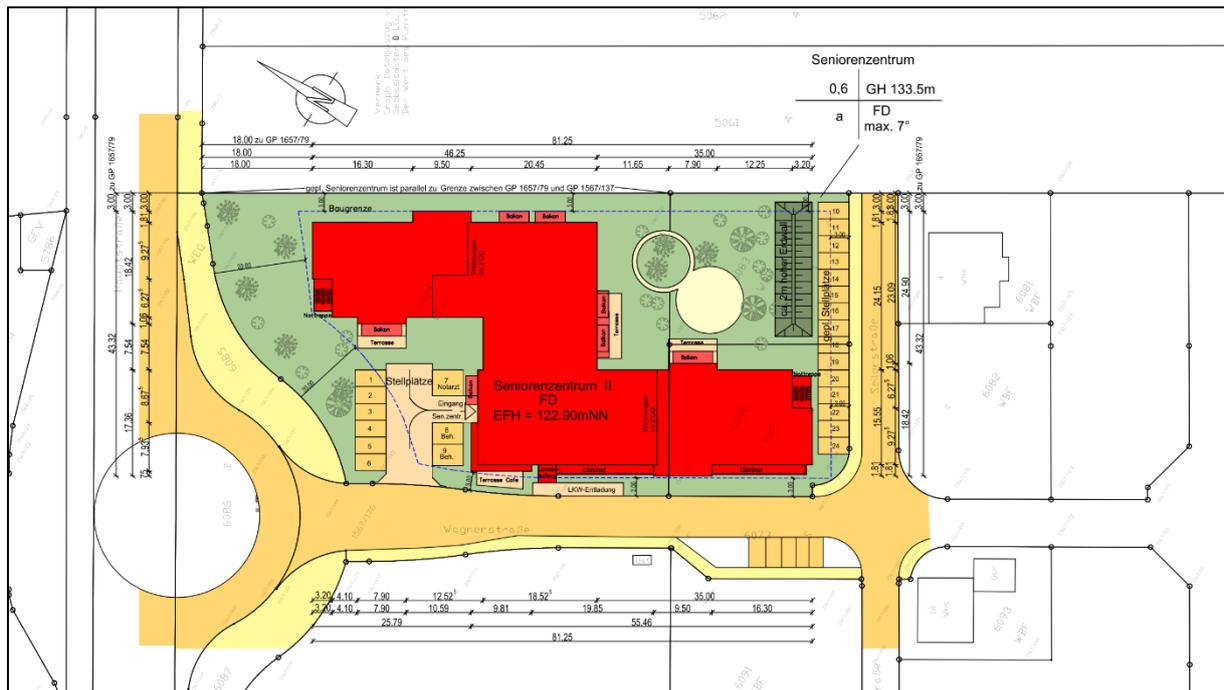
Neubau eines Seniorenzentrums in Hügelsheim, Lageplan; Quelle: Architekten- und Ingenieurbüro Gramlich und Partner, Limbach, 14.01.2020
